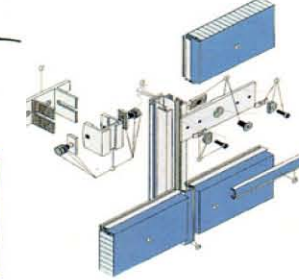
Sistema: Luxalon Fachada Ventilada / sub estructura de anclaje.
